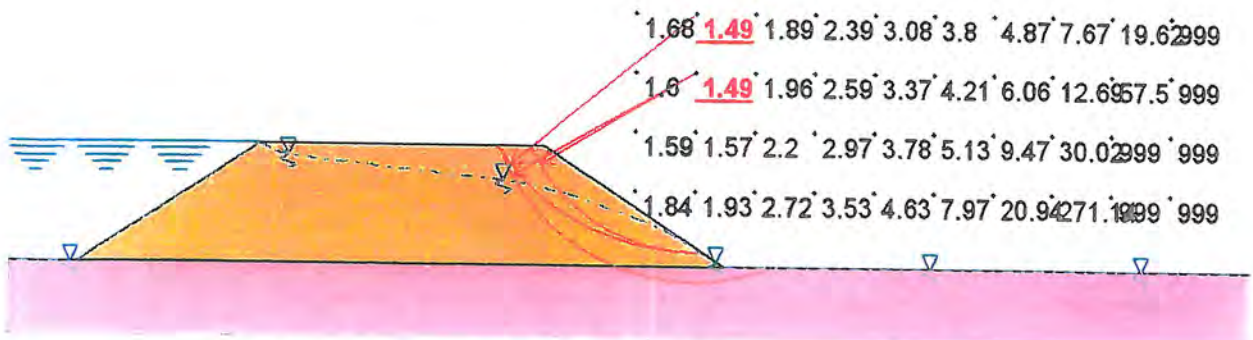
Glissement de talus pour un ouvrage fondé sur des argiles
